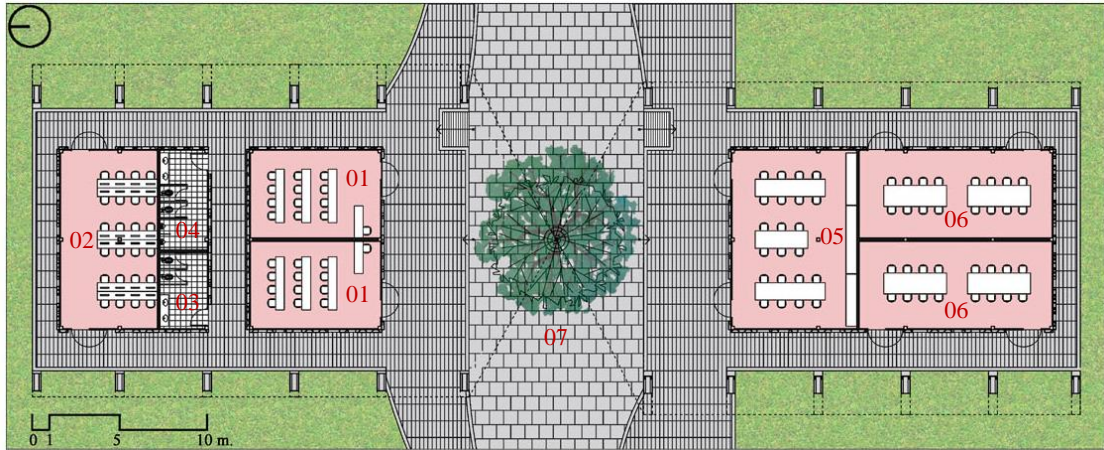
Planta bloque asesoramiento técnico. Elaboración propia.
